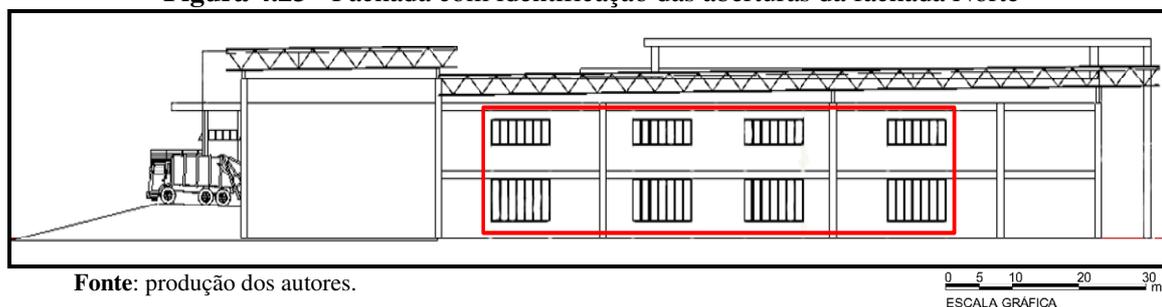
Corte com identificação das aberturas da fachada Norte
